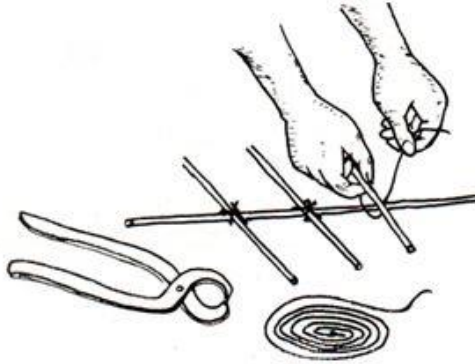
Scellement des armatures de ferrailage des dalles des fosses de la TCM
